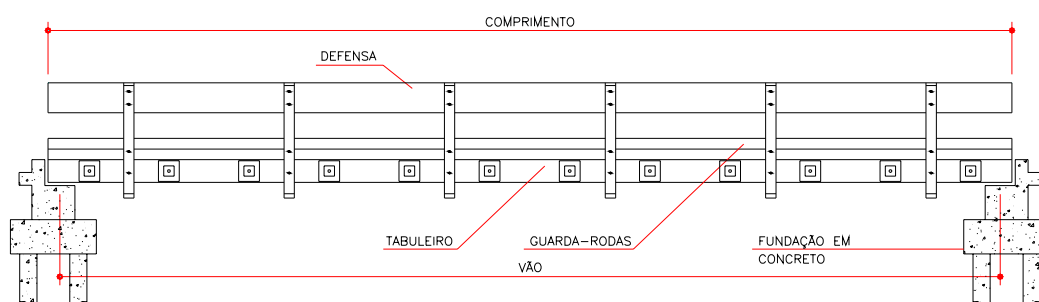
Vista lateral da ponte em placa protendida transversalmente
